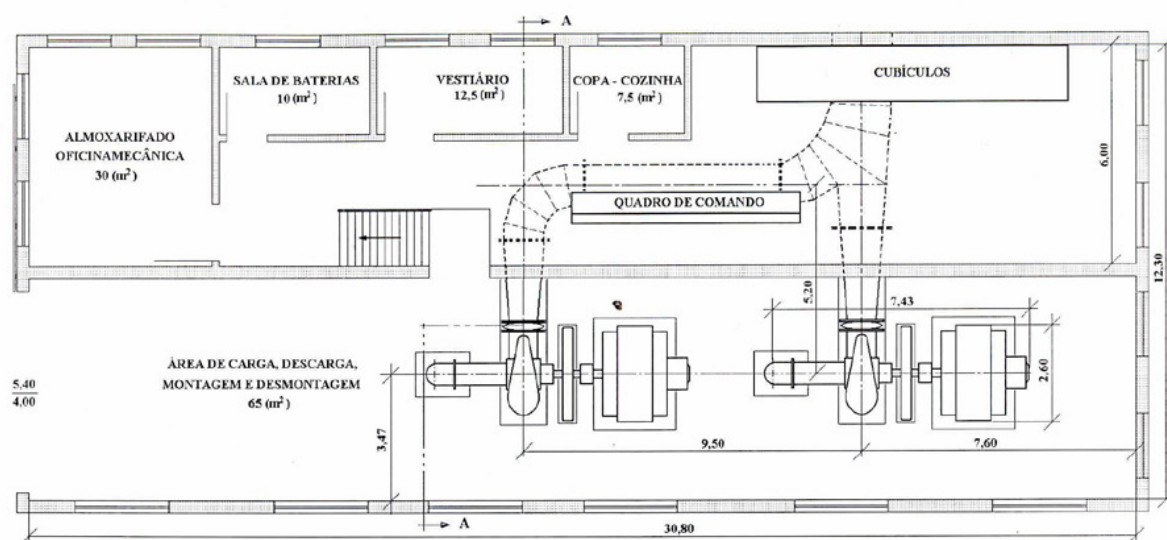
Central hidrelétrica – Planta da casa de máquinas.
